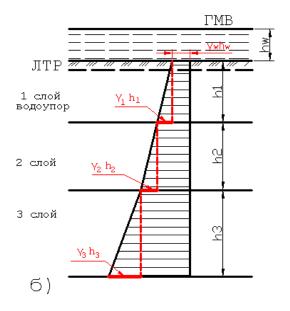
Расчетная схема для определения осадки фундамента: а) опоры на суходоле; б) промежуточной опоры.
